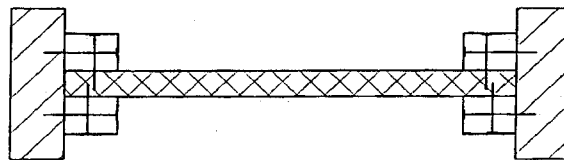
Beispiel für die Befestigung von Dämmplatten
